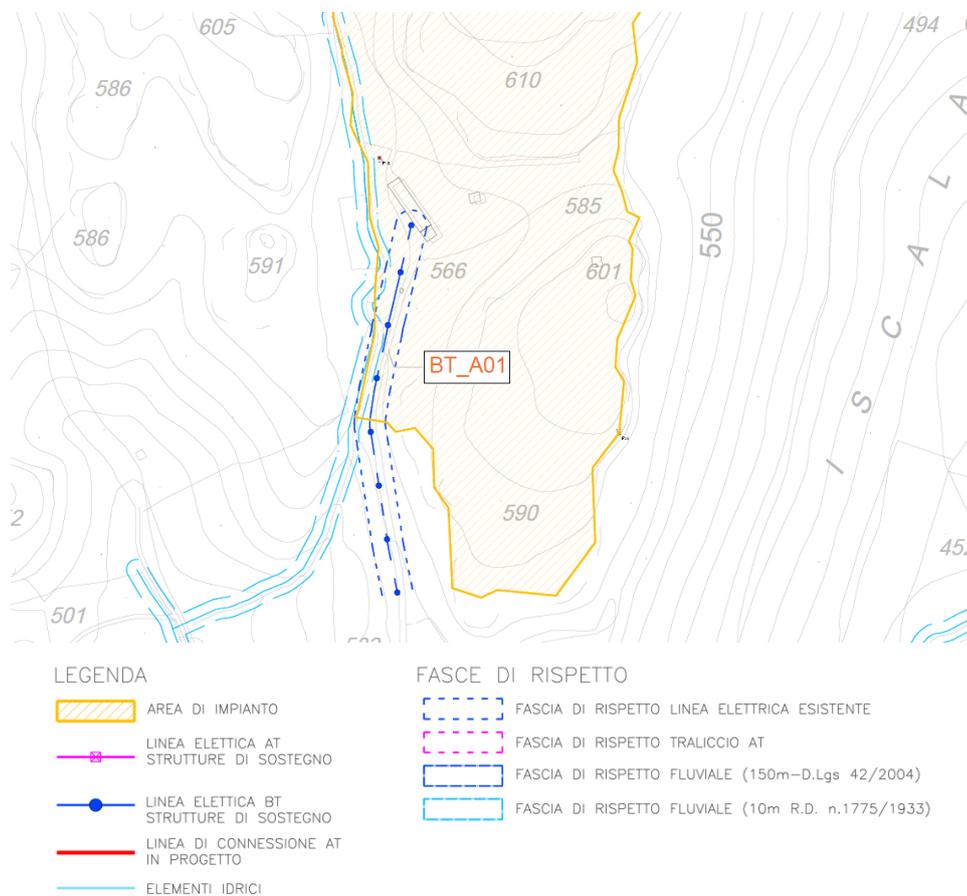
Risoluzione delle Interferenze nella zona sud dell'area lorda di installazione dell'impianto fotovoltaico.
